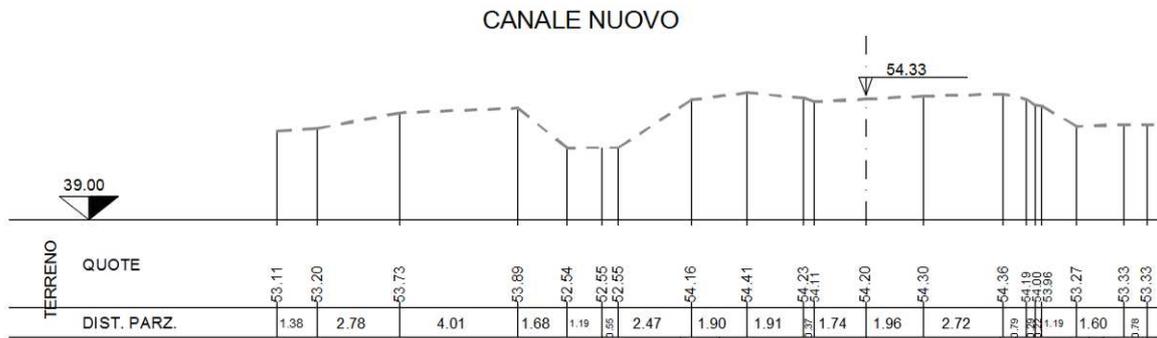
SEZIONE TOPOGRAFICA DEL CANALE NUOVO IN CORRISPONDENZA DELL'ATTRAVERSAMENTO IN PROGETTO
